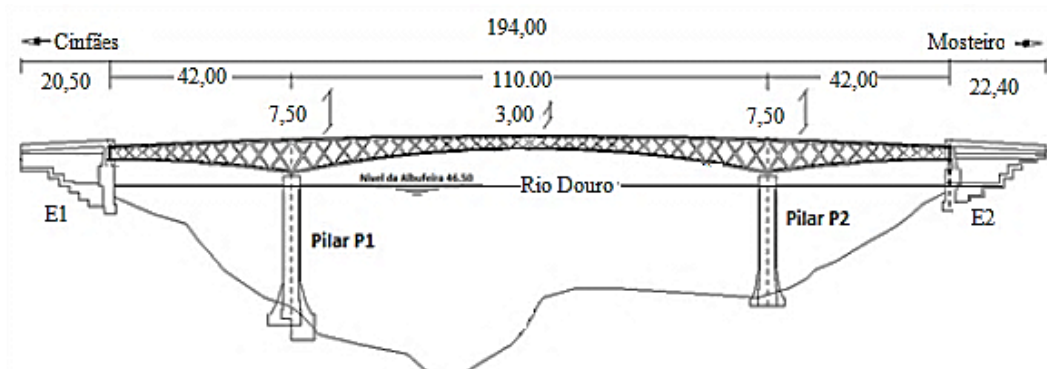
Corte longitudinal da Ponte de Mosteirô sobre o Rio Douro (EP, 2009b).
